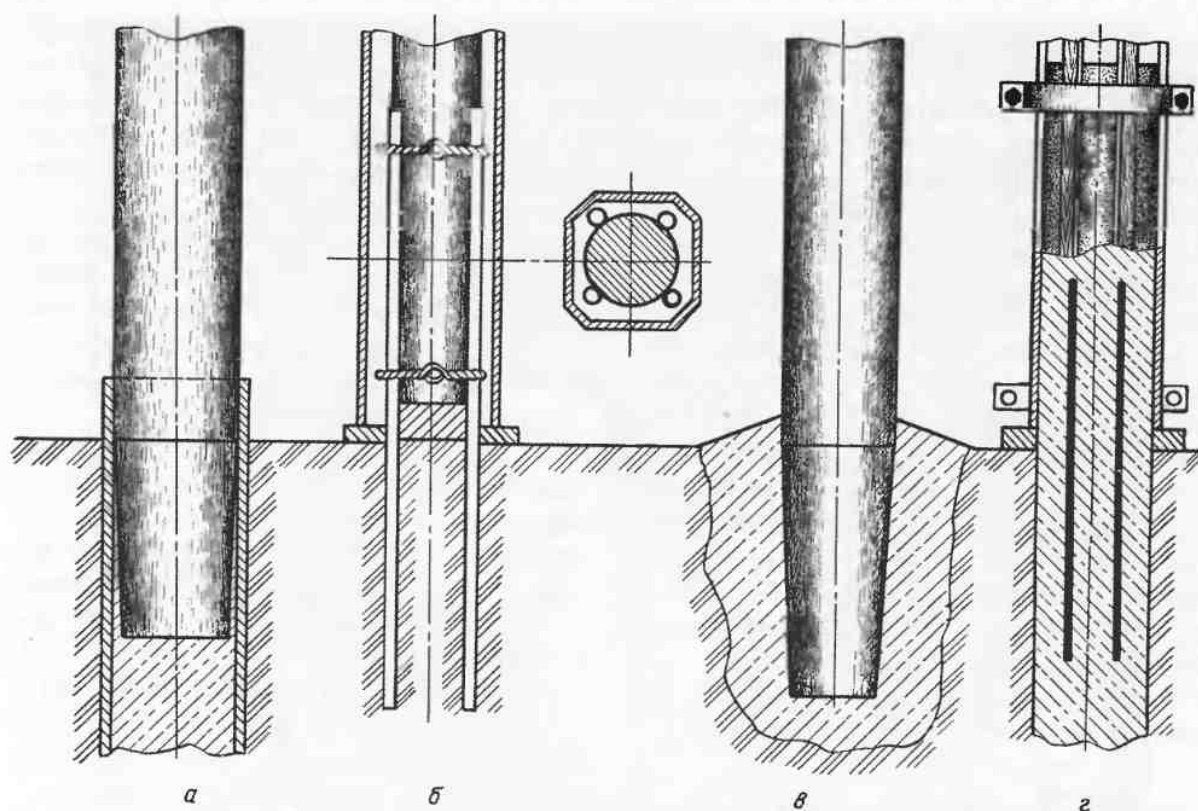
Примеры крепления в грунте опор конструкций, подверженных ветровой нагрузке: а — с погружением в металлическую трубу, закопанную в землю и залитую бетоном; б — сжатием проволоочной закрутки между четырьмя металлическими стержнями (трубами, уголками, швеллерами), вбитыми или закопанными в грунт; в — с заливкой бетоном посадочного конца в яме (поверхность бетона выступает над уровнем грунта); з — с обжимом внешнего короба колонны полухомутиками вокруг цементного или бетонного столбика на арматуре
